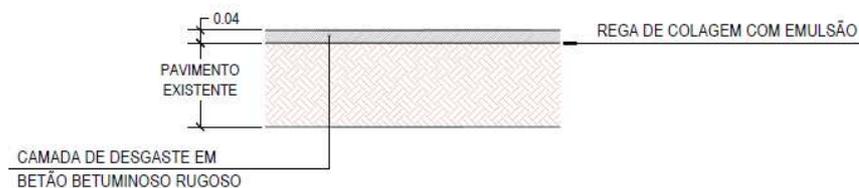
| Pavimentação - Zonas de Fresagem e Repavimentação
